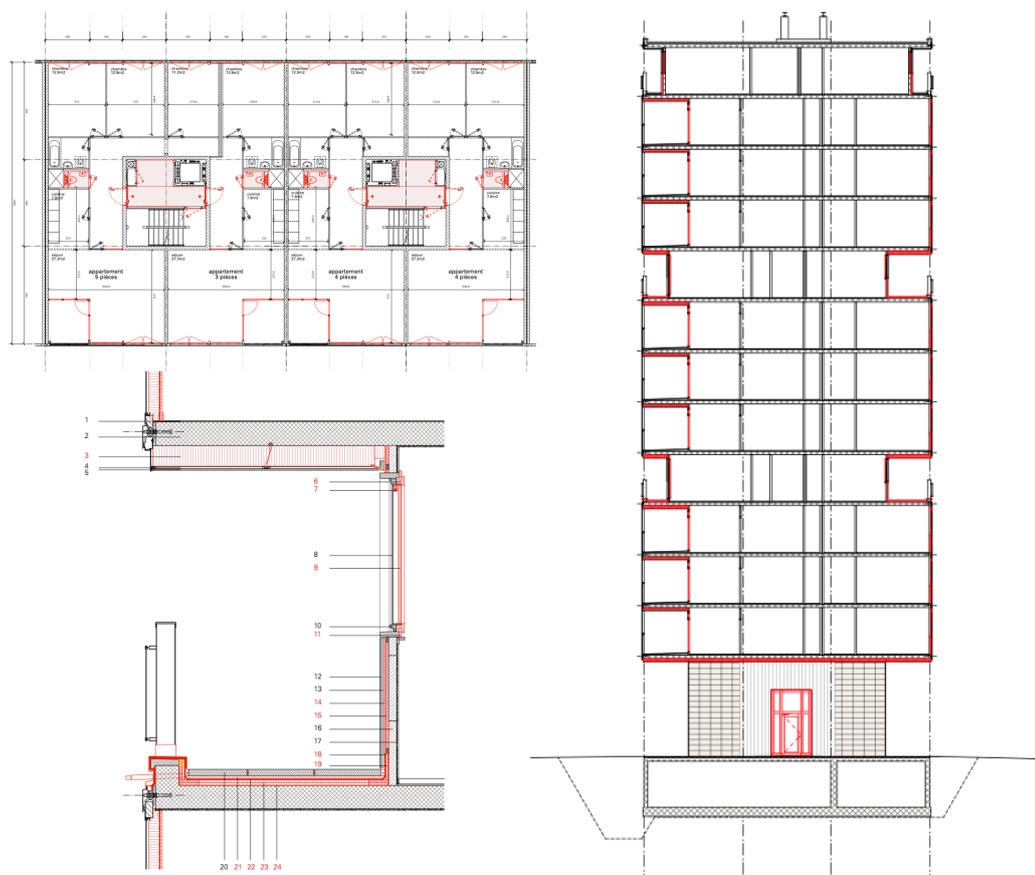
Cité le Lignon / Grundriss, Querschnitt & Fassadendetail
